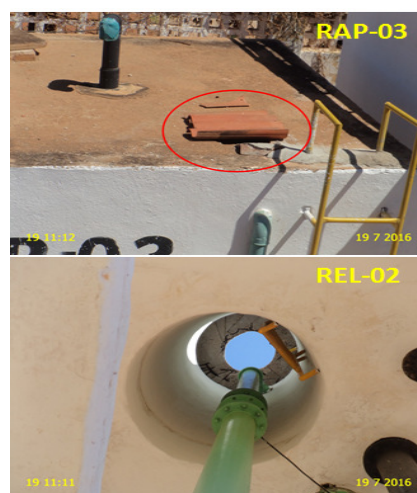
RAP-03/REL-02: Ausência de tampa de inspeção.
